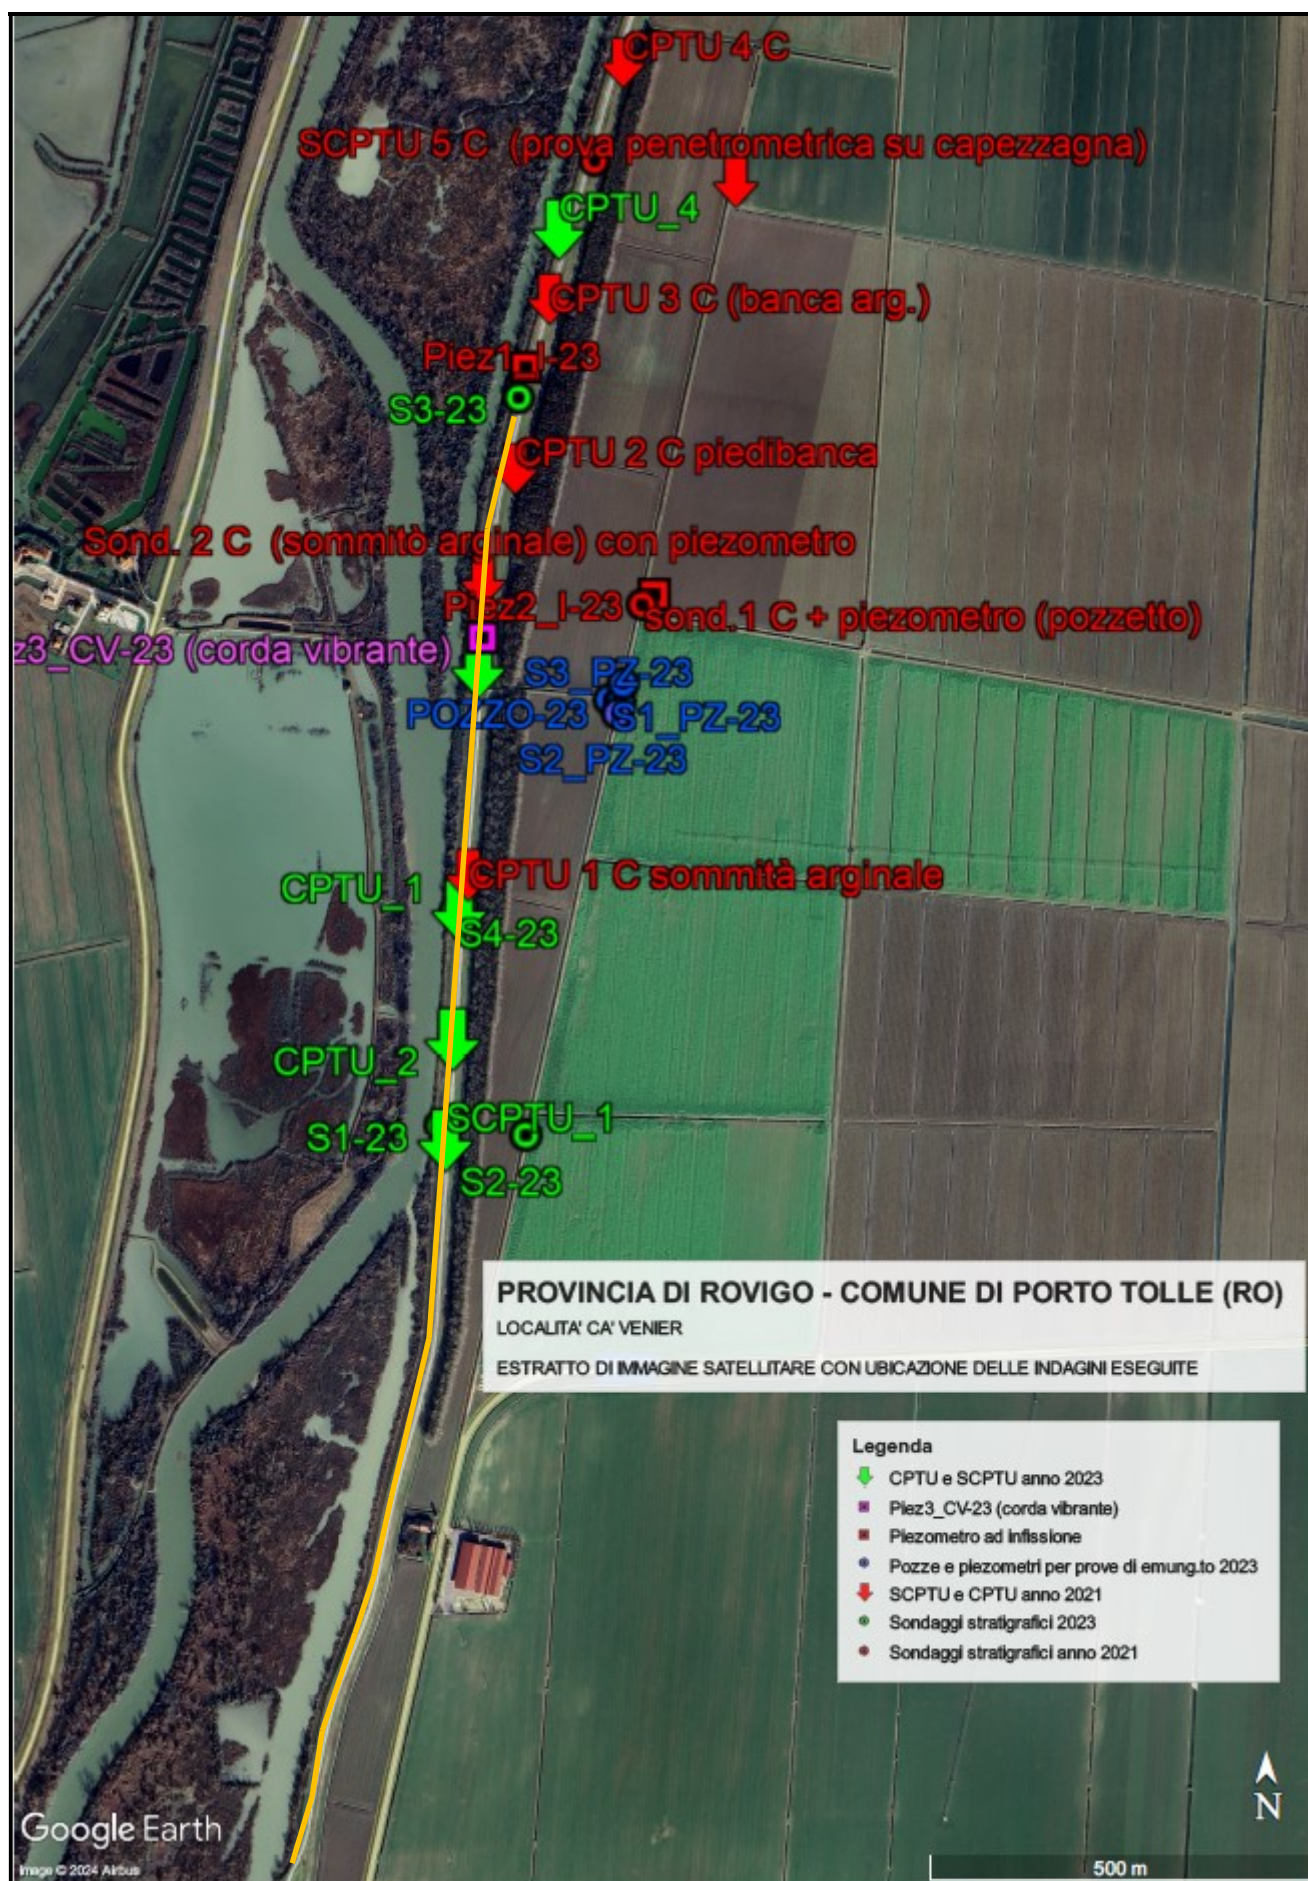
Planimetria con ubicazione delle indagini effettuate nell'area dell'intervento
